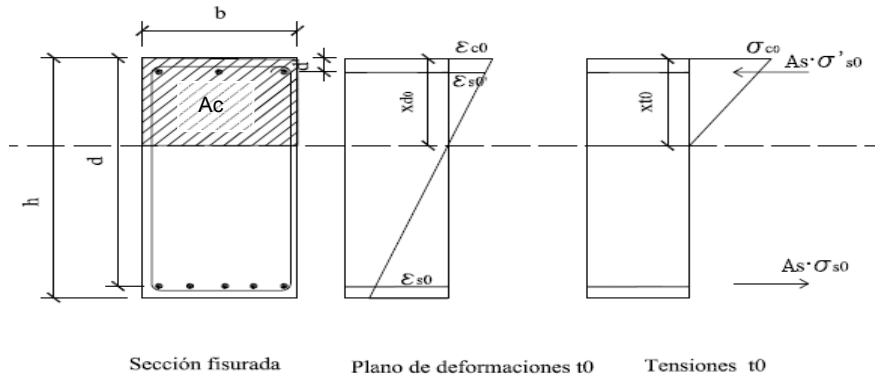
Plano de deformaciones y tensiones instantáneas en una sección fisurada.
